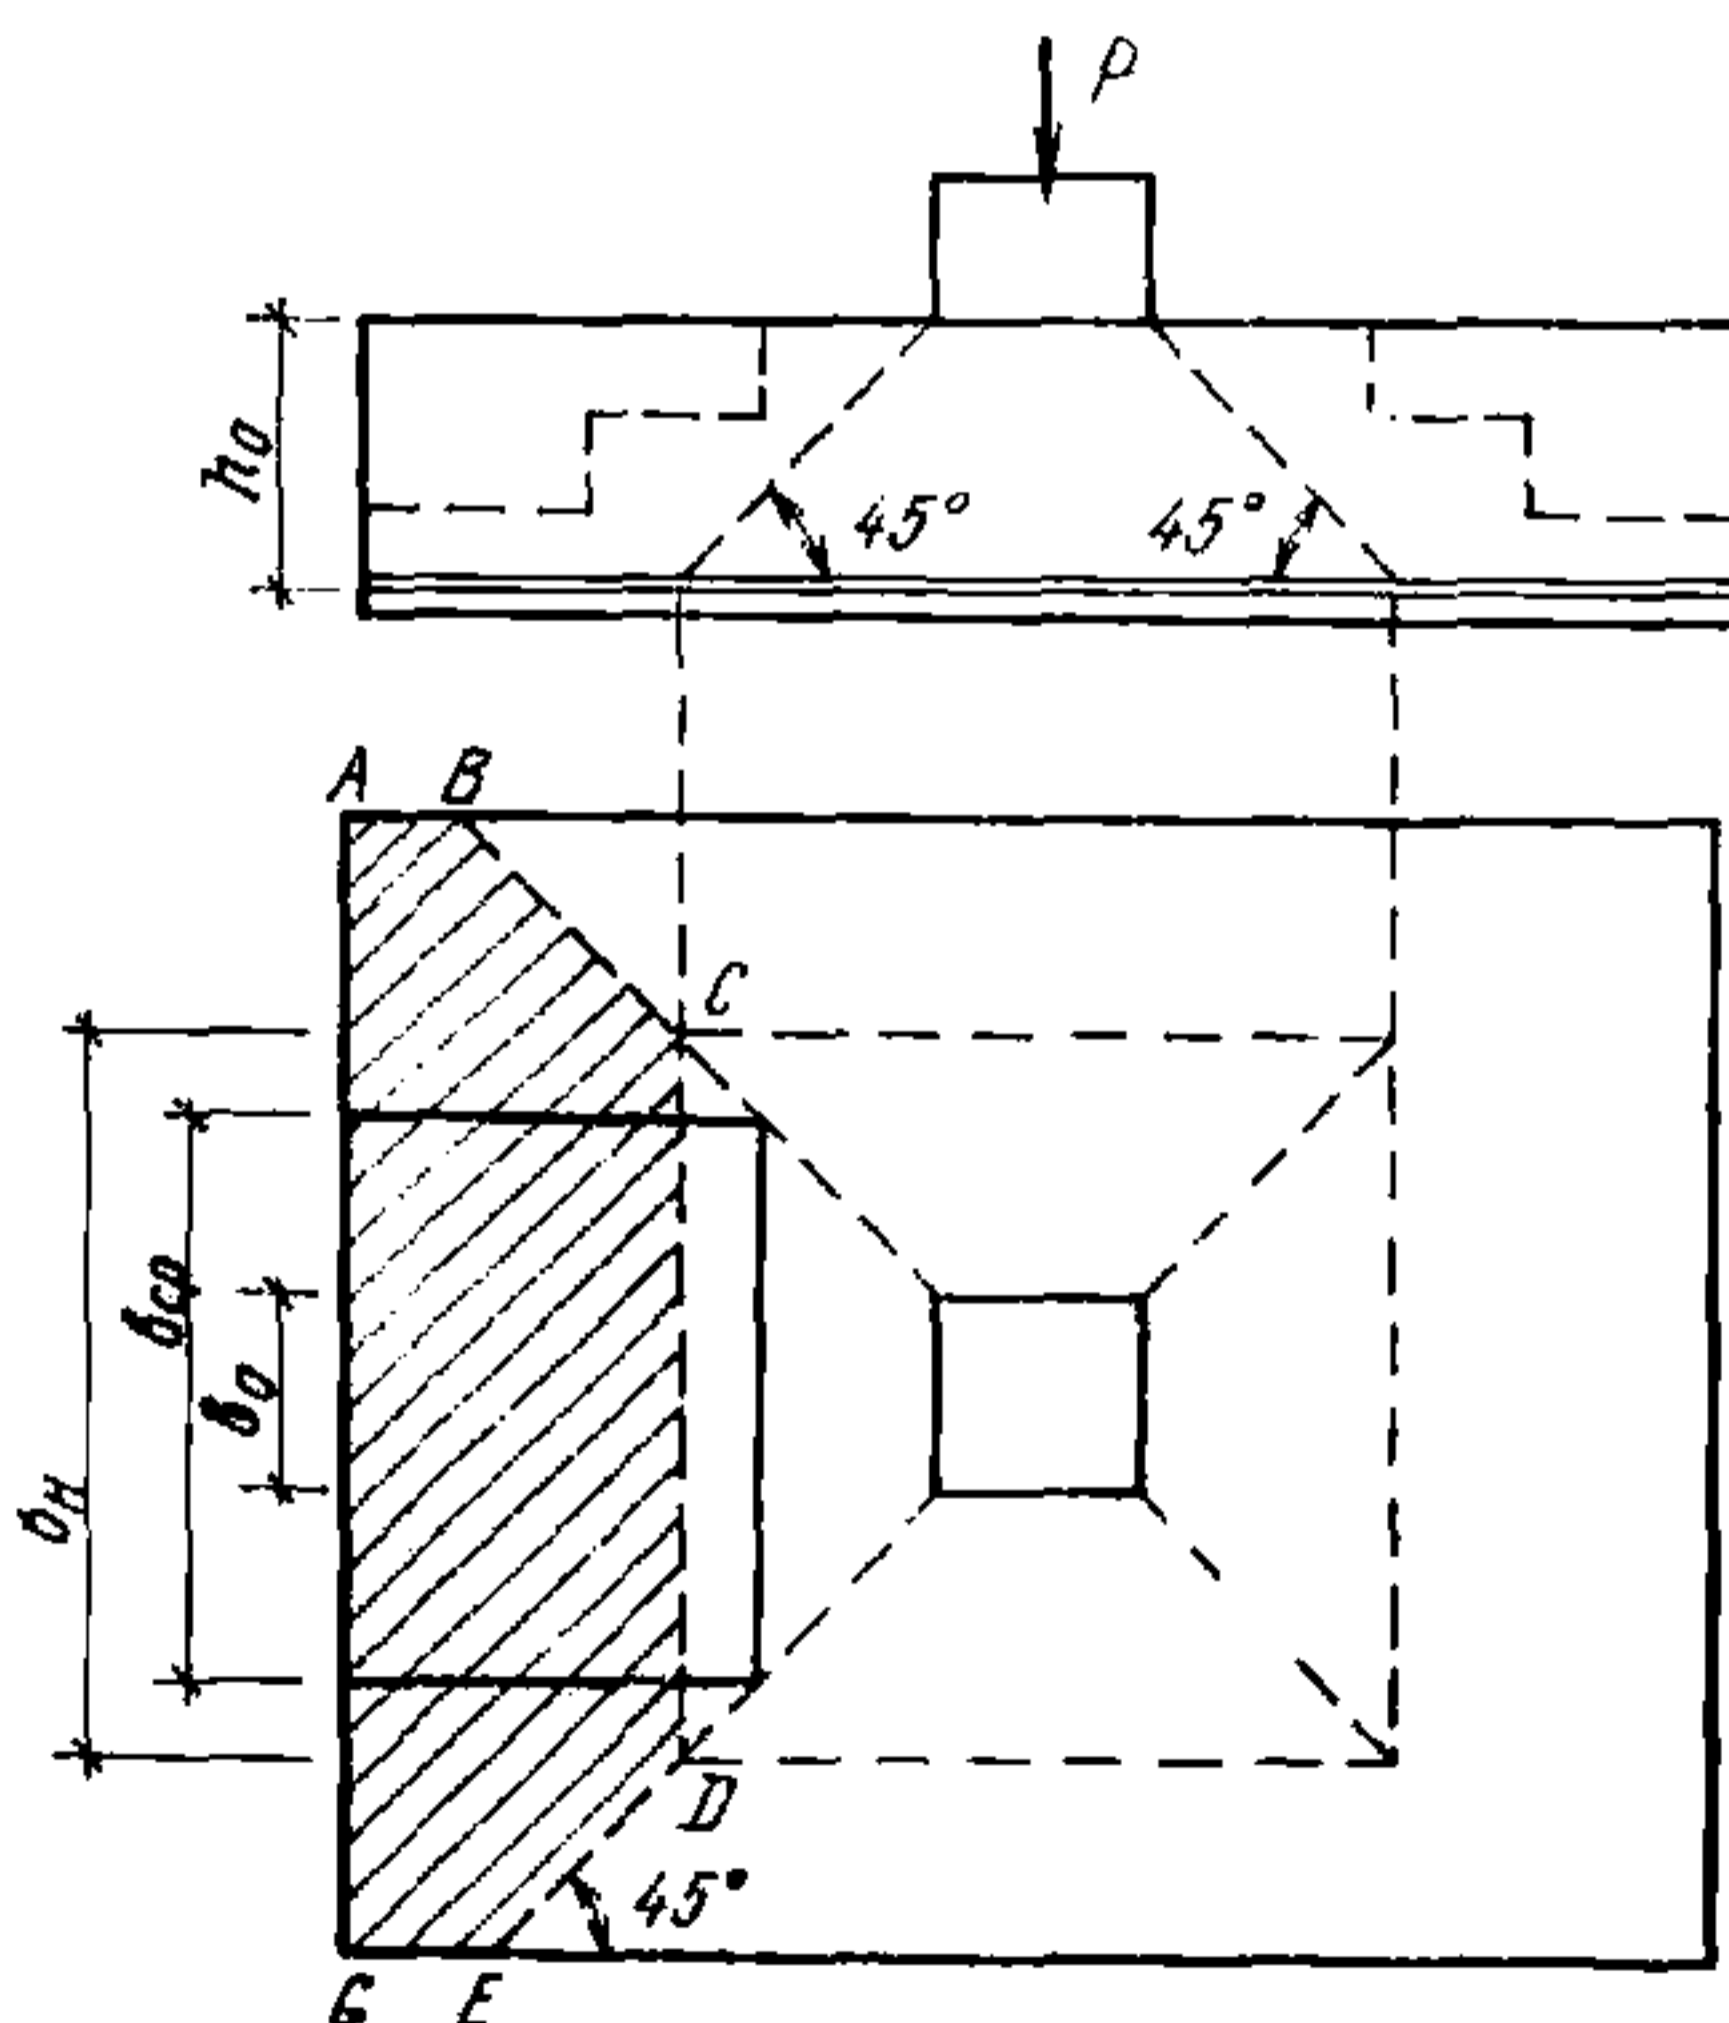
Схема образования пирамиды продавливания в железобетонном фундаменте
